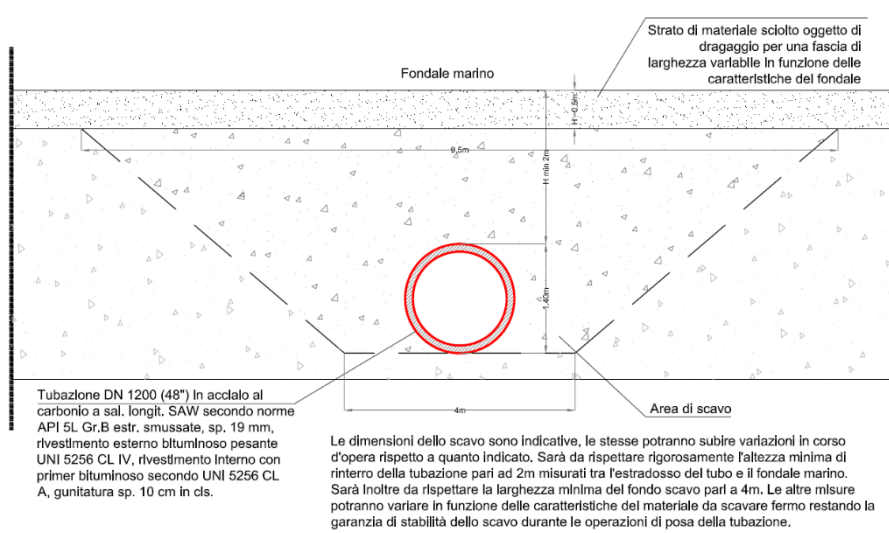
Sezione tipo di posa condotta esistente nel tratto interno diga foranea esistente (Fonte IRETI).
